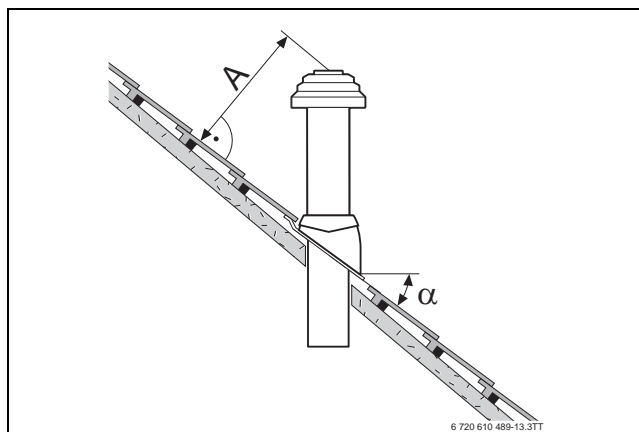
Abstandsmaße und Dachneigungen bei Schrägdach
